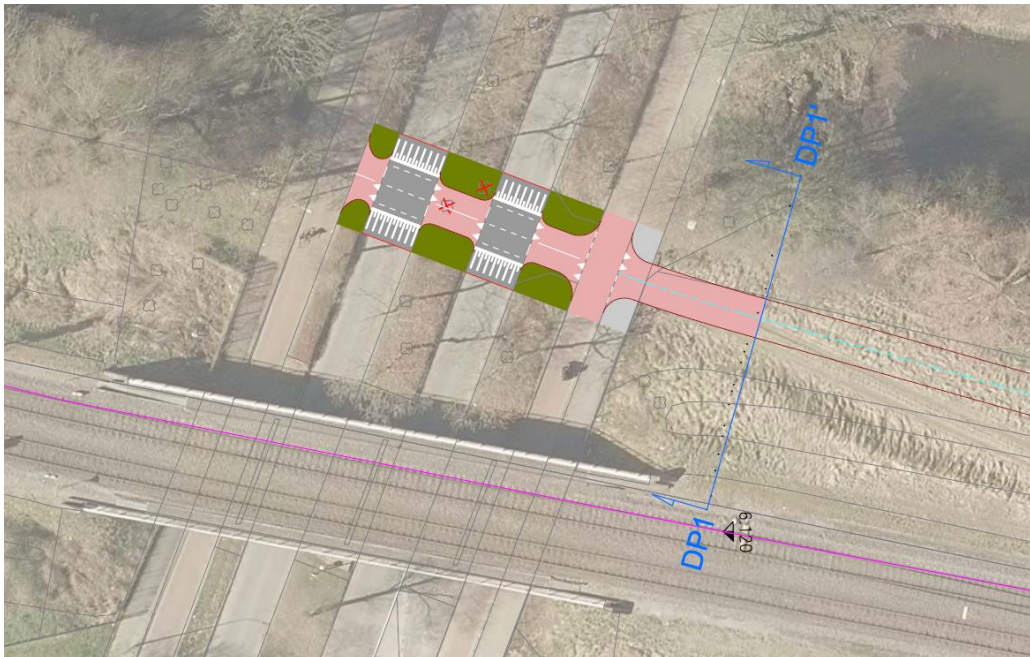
Groenplan Grote Beerstraat plus deel fietsroute Stadhouderslaan
